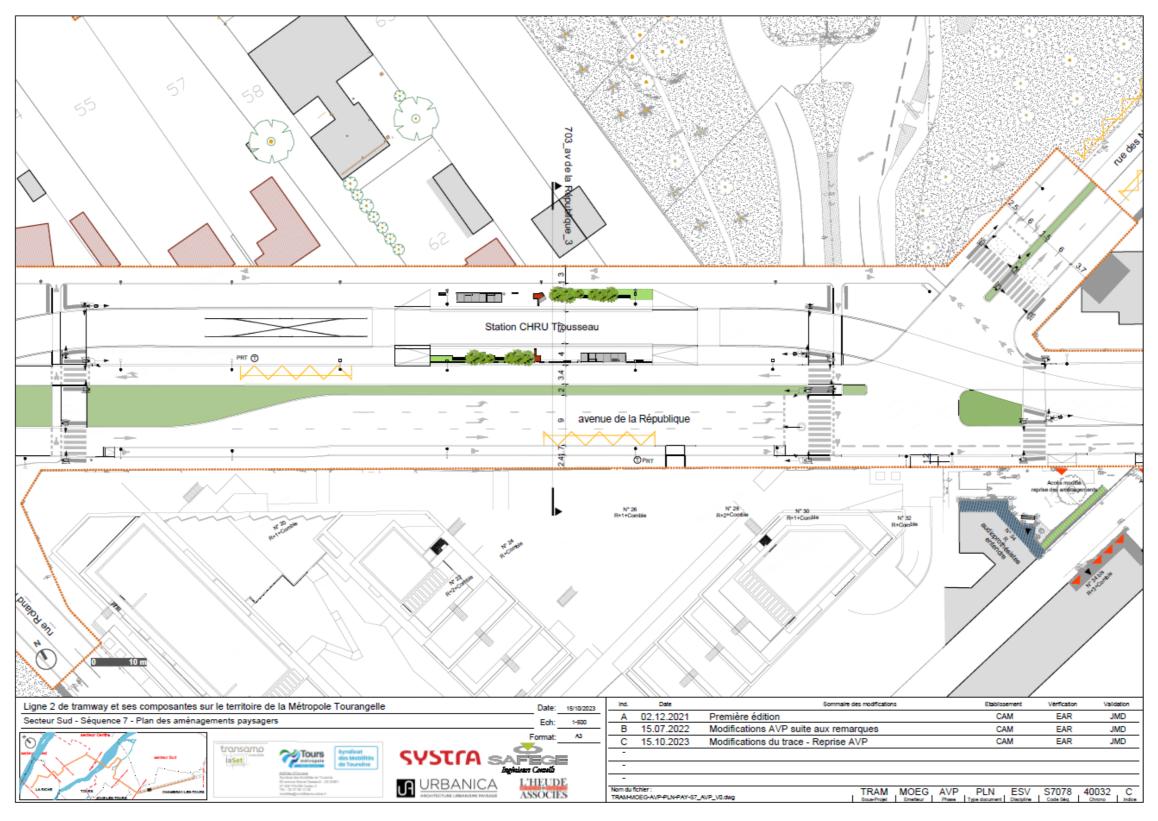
plan masse de localisation des arbres à abattre sur avenue de la République – Section 2 (planche 6)
